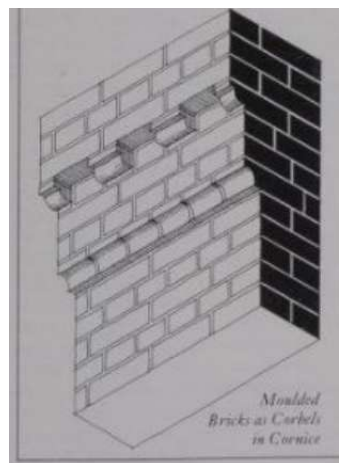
Fuente: Plumridge, Andrew - *Brickwork architecture and design* (2000) Pag 185
